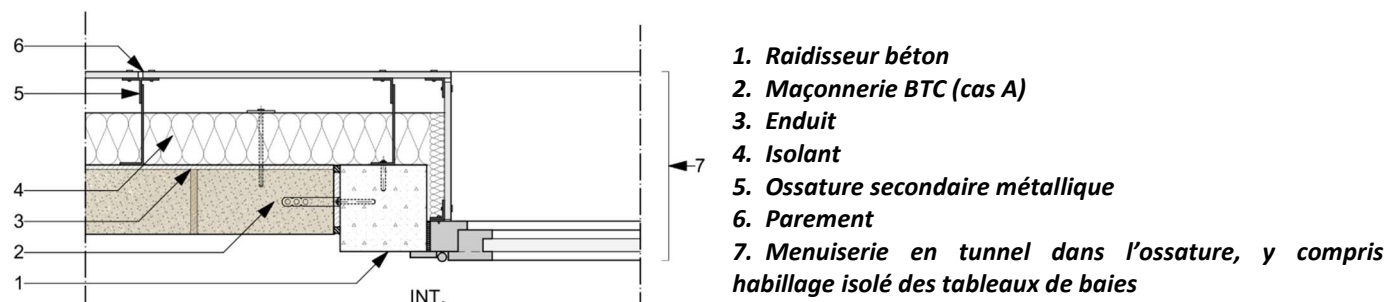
Exemple en plan d'intégration de baie en ossature béton (cas B)
